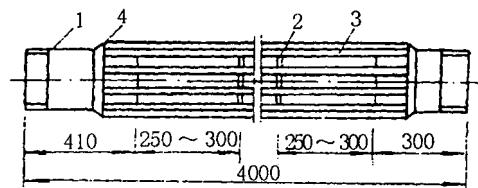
钢筋骨架过滤器（标注尺寸单位：mm）
